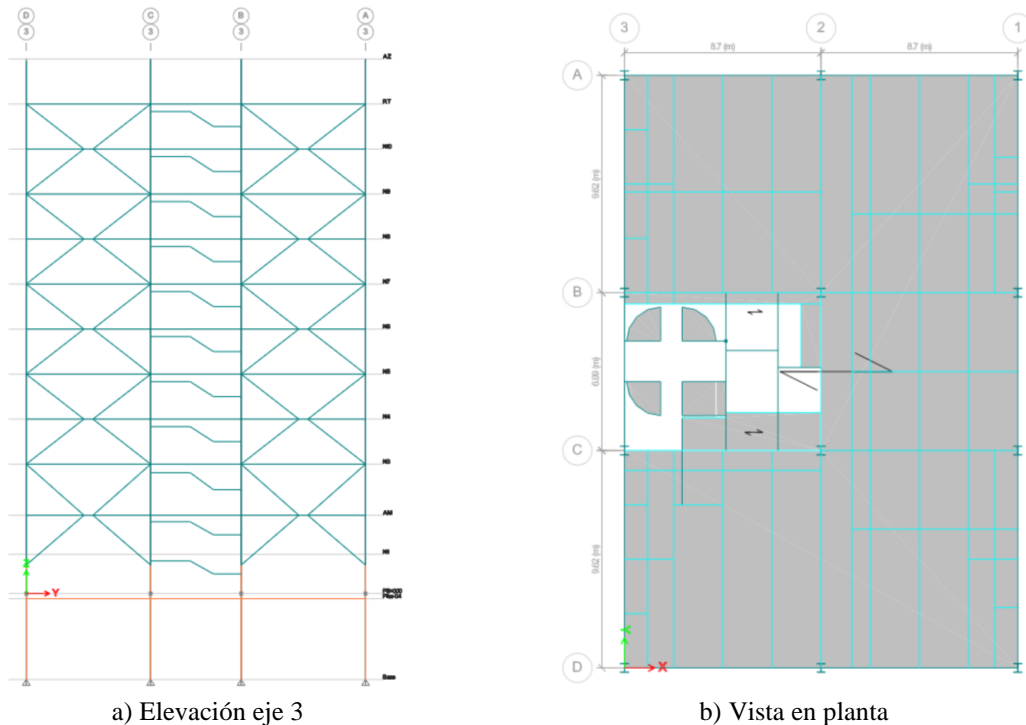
Vista generales de la estructura con contravientos convencionales (CC)
